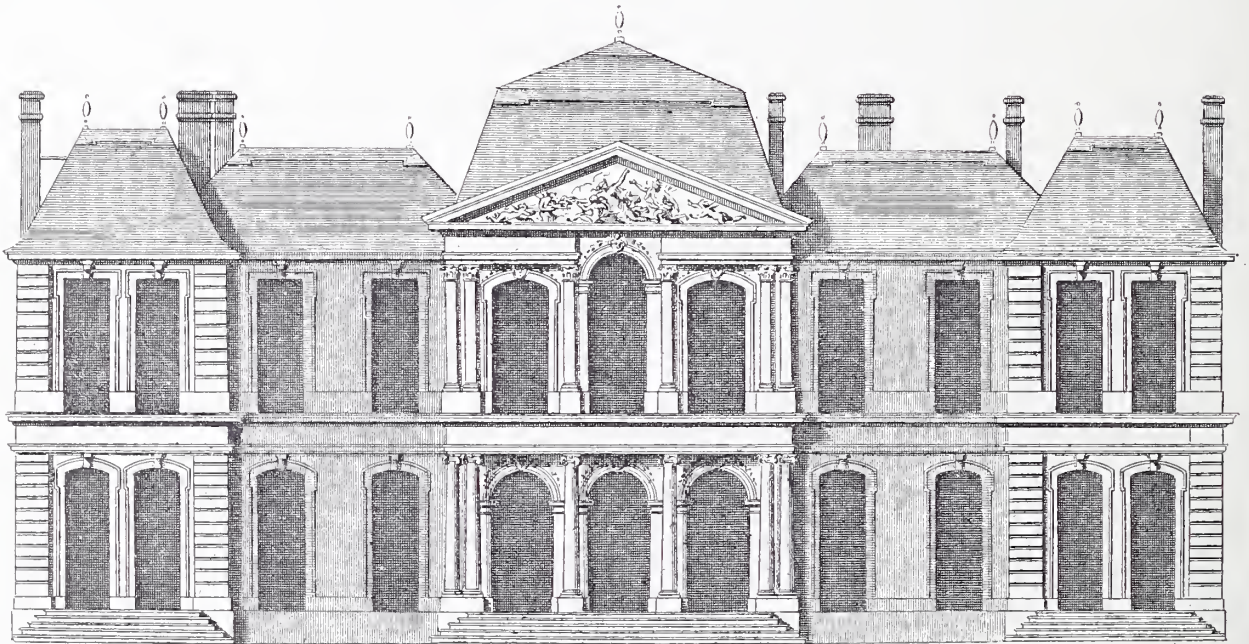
Hôtel Desmarets, construit par Lassurance (façade sur le jardin).
